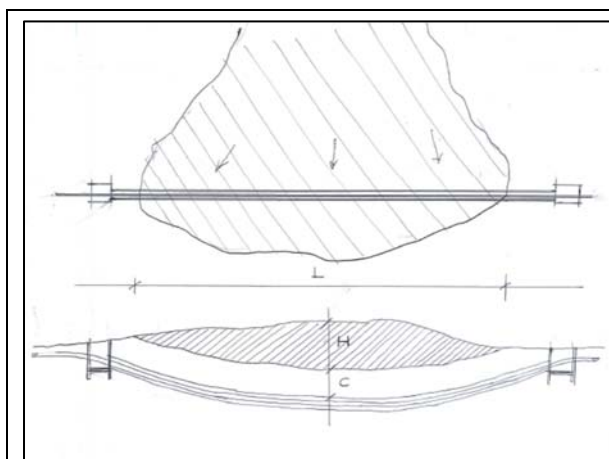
/A – Esempio schematico di un attraversamento “Trenchless” sotto la superficie di scorrimento di un movimento franosi
